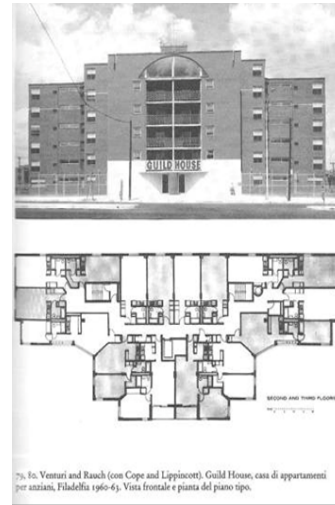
Residencia de ancianos Guild House. Fachada principal y planta de vivienda. Spring Garden Street, Philadelphia, 1961.
